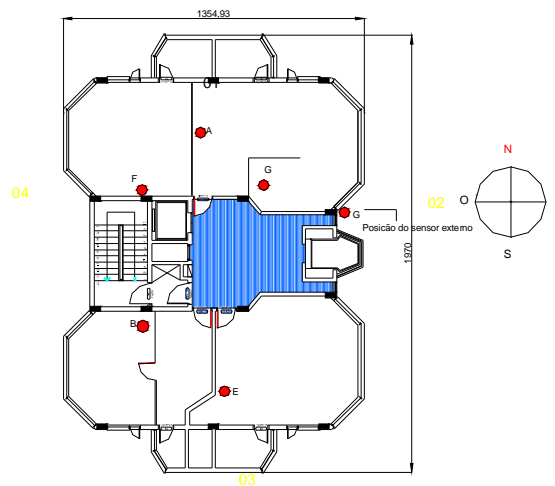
Planta do Edifício Panorama, 1º Monitoramento.
